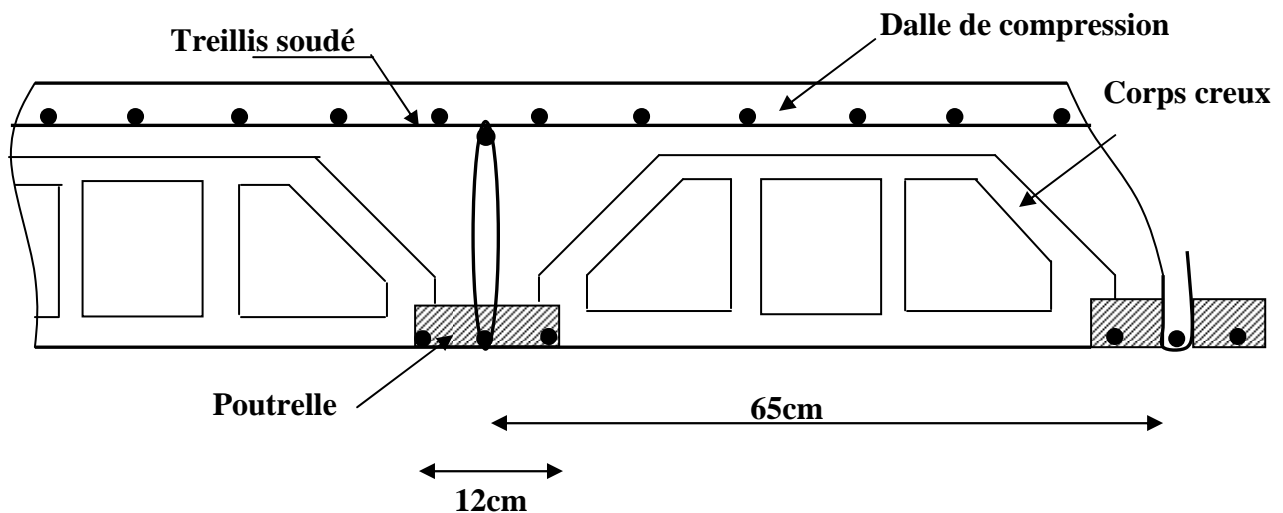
Eléments constitutif d'un plancher a corps creux
